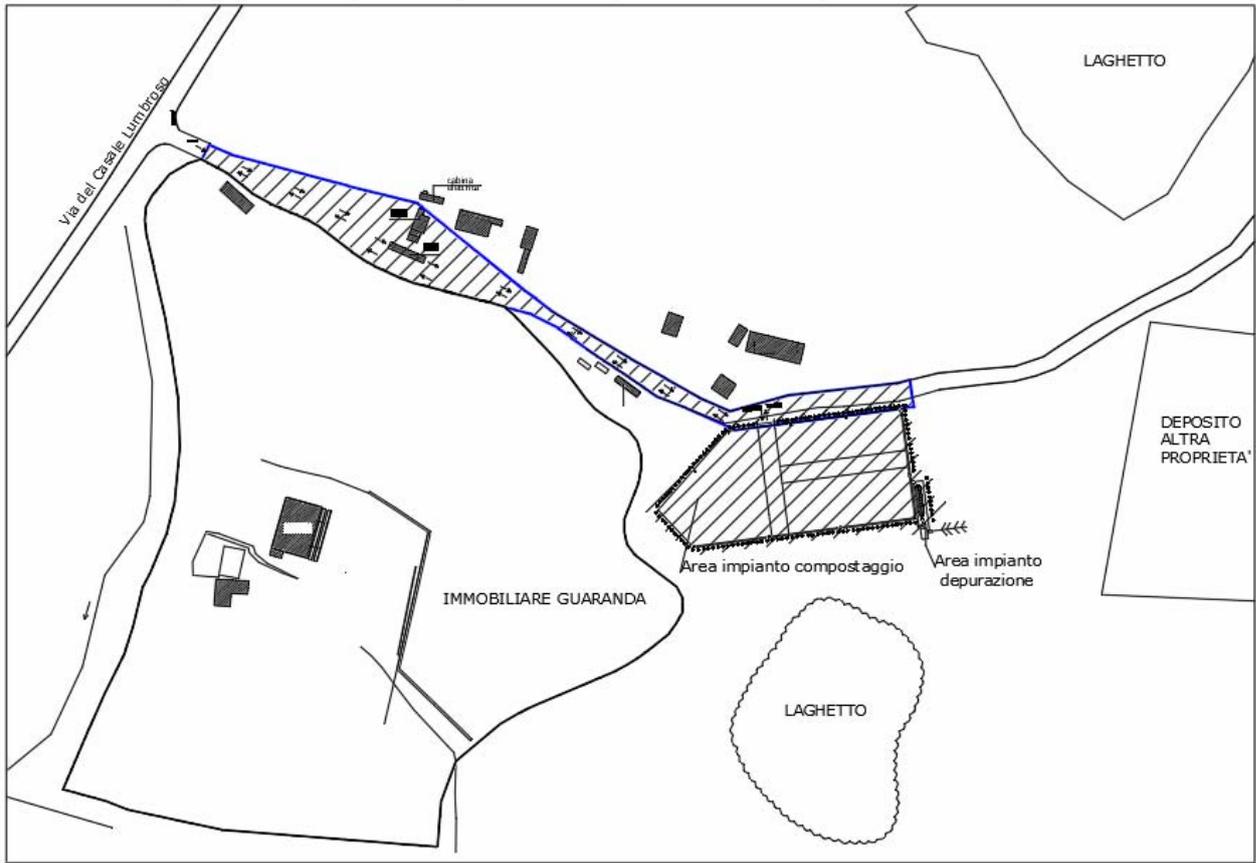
Planimetria generale dell'impianto nello stato attuale
